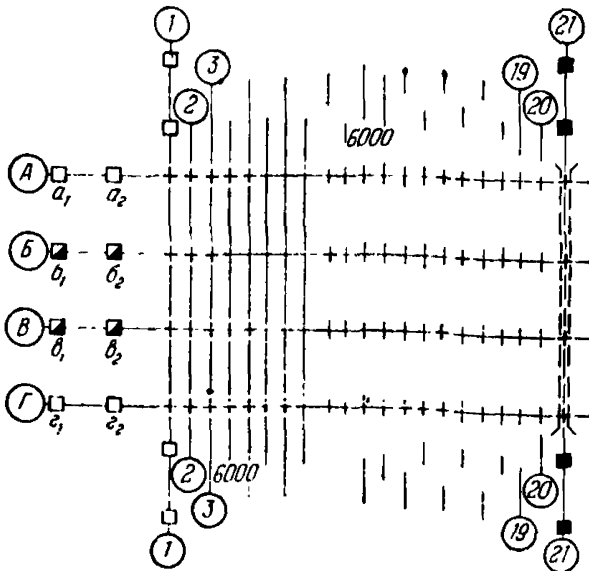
Схема детального построения основных, межсекционных и пролетных осей на фундаментах промышленного здания
